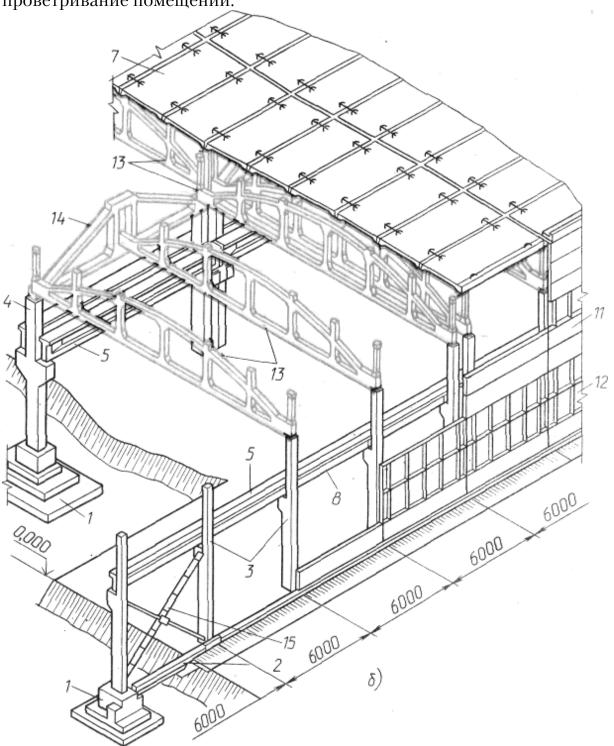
Производственное многопролетное здание с железобетонным рамно-пролетным каркасом: 1 — фундаменты, 2 — фундаментные балки, 3 — колонны крайнего ряда, 4 — колонны среднего ряда, 5 — подкрановые балки, 6 — балки покрытия, 7 — плиты покрытия, 8 — зенитные фонари, 9 — воронка водостока, 10 — рулонное покрытие кровли, 11 — панели стен, 12 — оконные переплеты, 13 — стропильные фермы, 14 — подстропильная ферма, 15 — вертикальная связь
